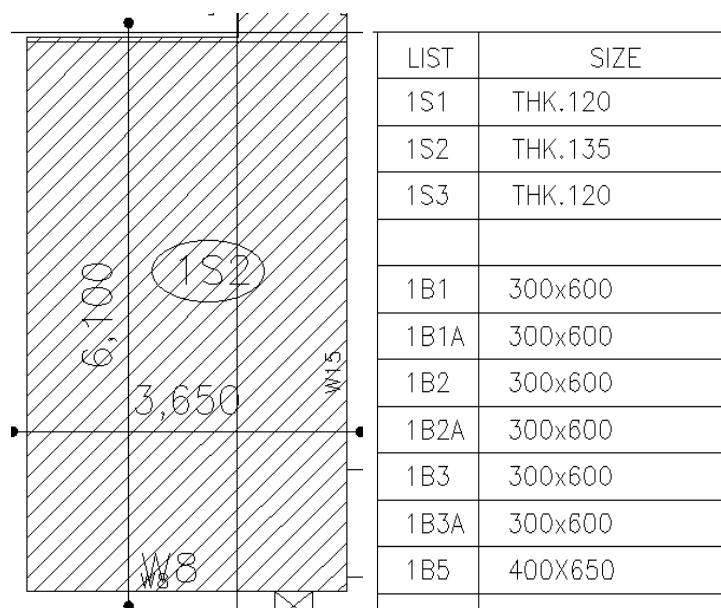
Dalle pleine en BA et épaisseurs de quelques éléments structuraux situés dans le 1er étage
